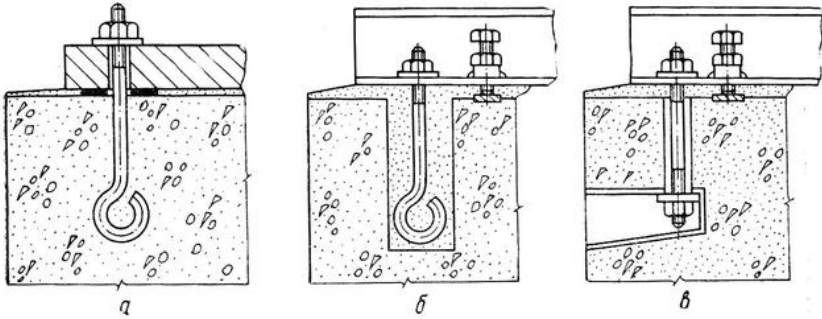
Кріплення насосного агрегата до фундаменту:
